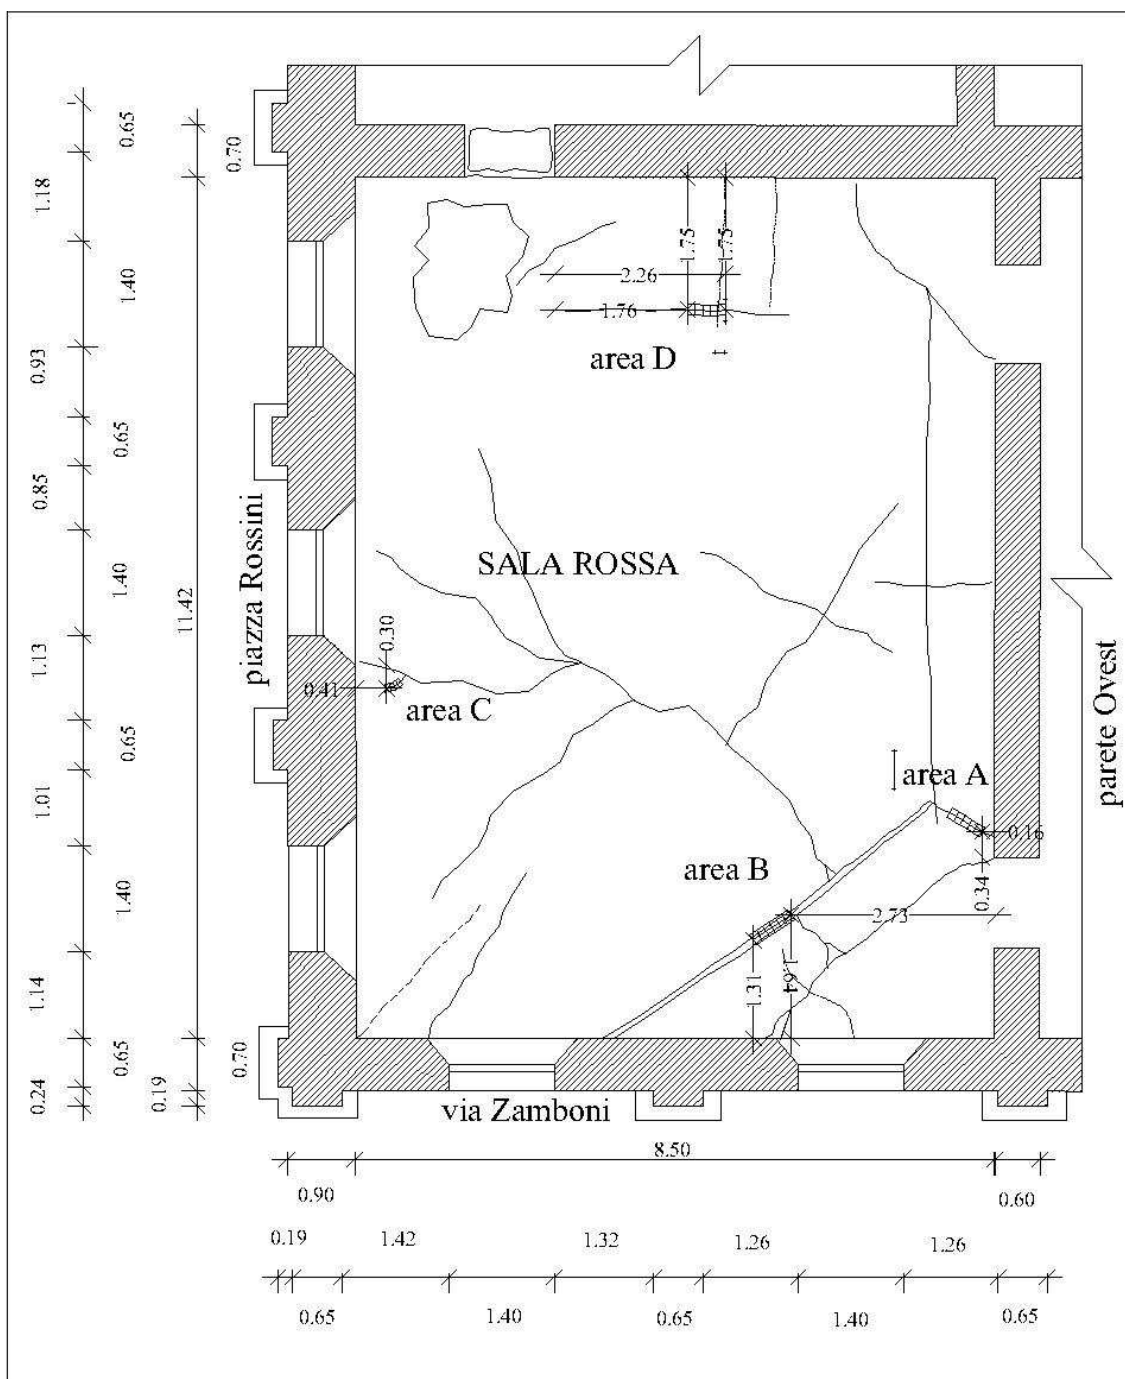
Pianta della sala Rossa: rappresentazione dello stato fessurativo del pavimento e postazioni di prova (modificato da Capobianchi, 2009).
